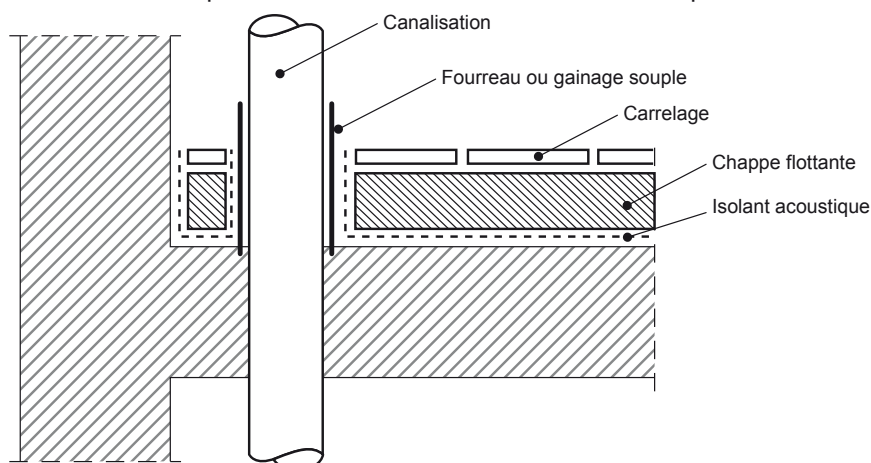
canalisation entourée d'un fourreau ou d'une bande compressible dans la traversée
